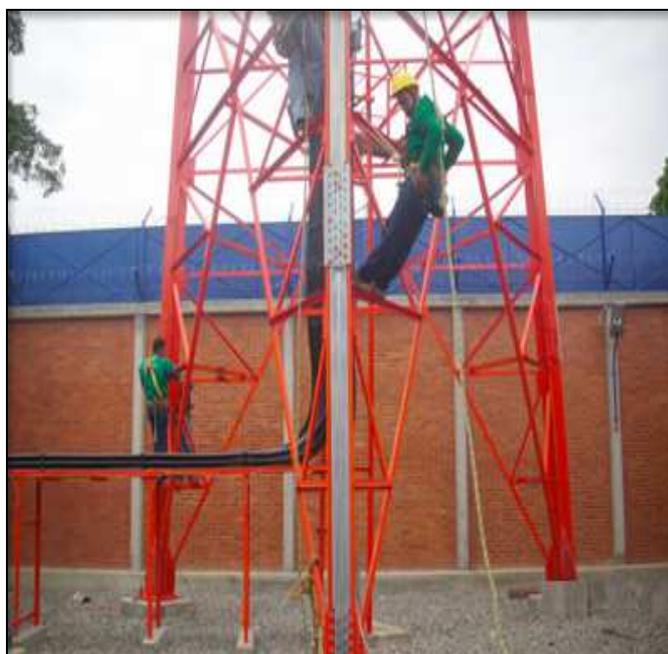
Torre auto soportada con escalerilla para cables guía de onda
